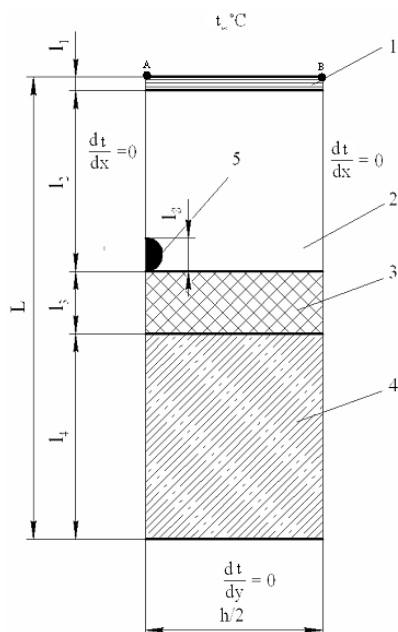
Схема исследуемой области: 1 – напольное покрытие; 2 – бетонная стяжка; 3 – теплоизолирующее покрытие; 4 – плита перекрытия; 5 – источник тепла
